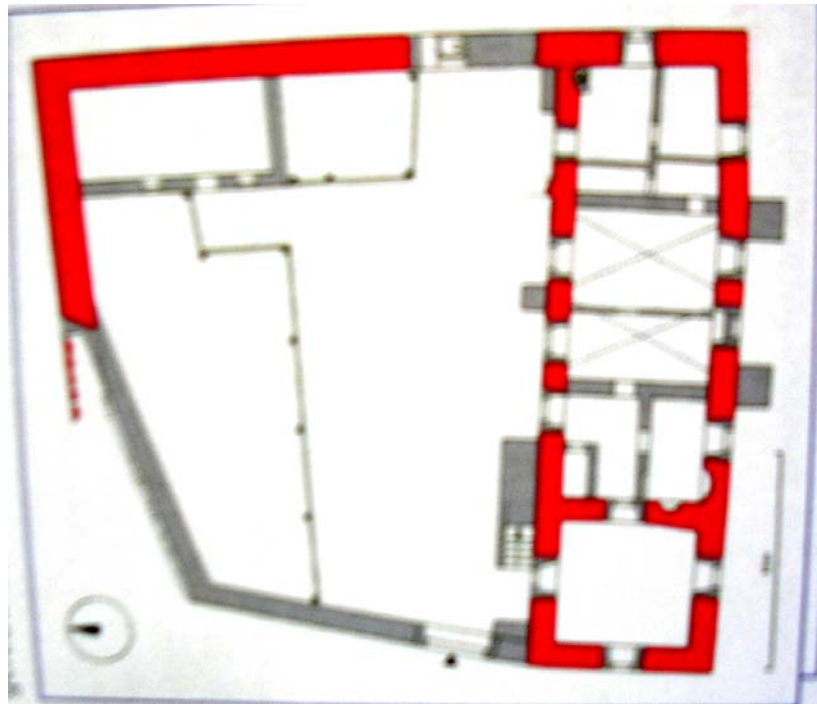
Grundriss des Schlosses Oberrußbach.
